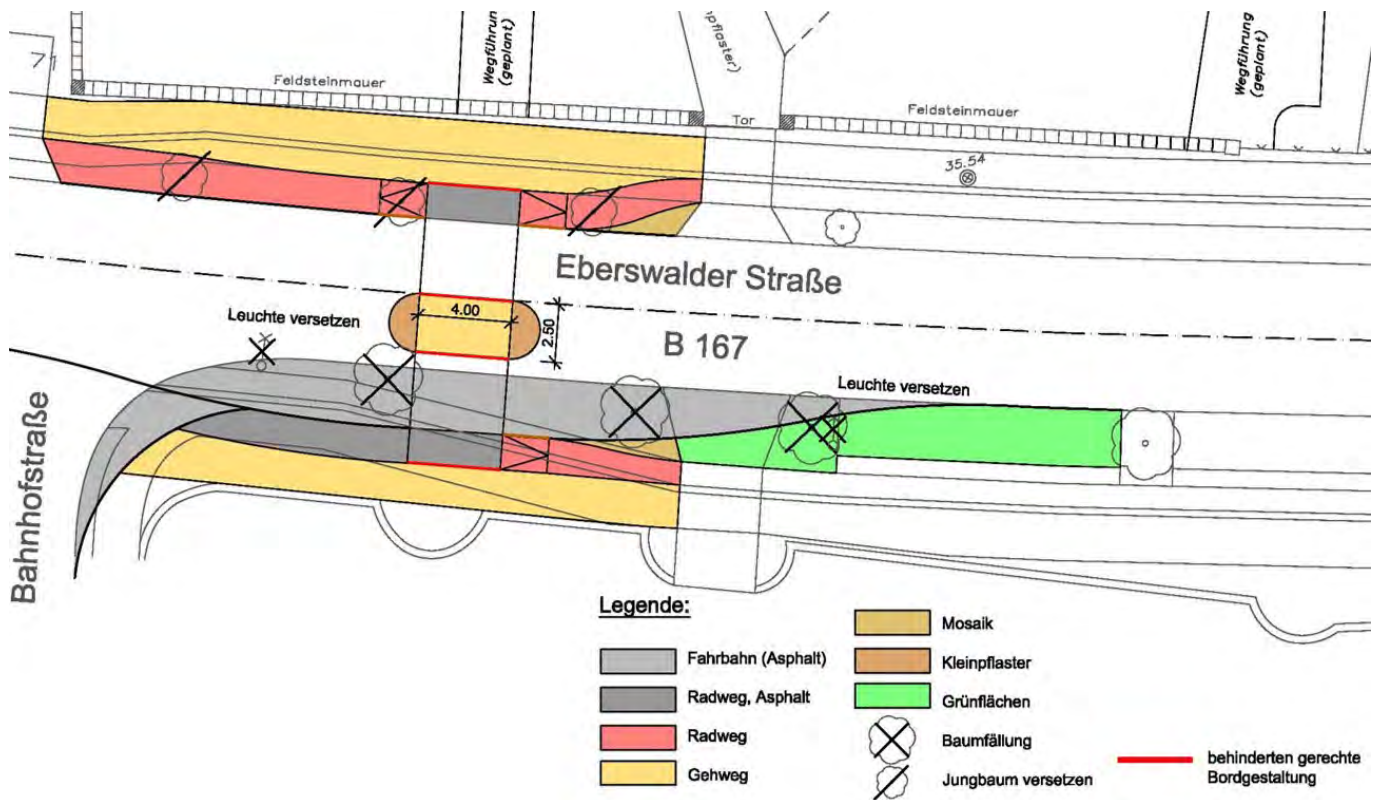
Fußgängerquerung Eberswalder Straße im Bereich der ev. Kirche Finow
